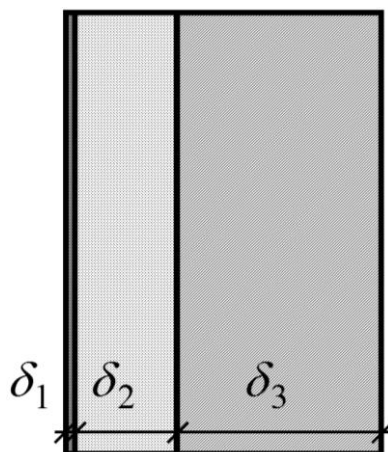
Расчетная схема наружной стены жилого дома
